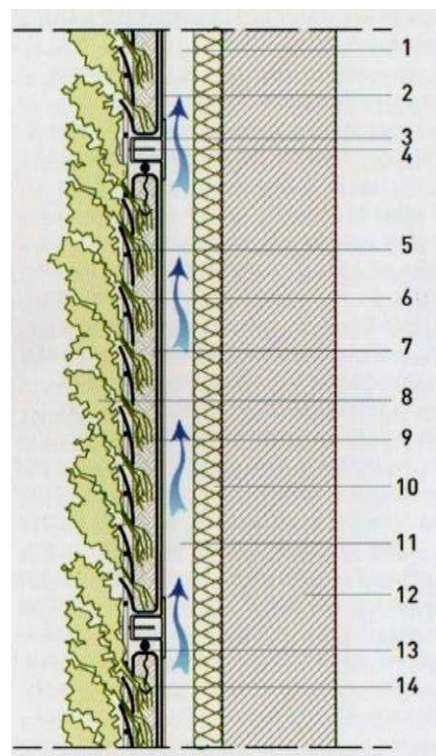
Corte explicativo de uma Parede Viva tipo Muro Cortina. (retirado de Garrido, 2011)
